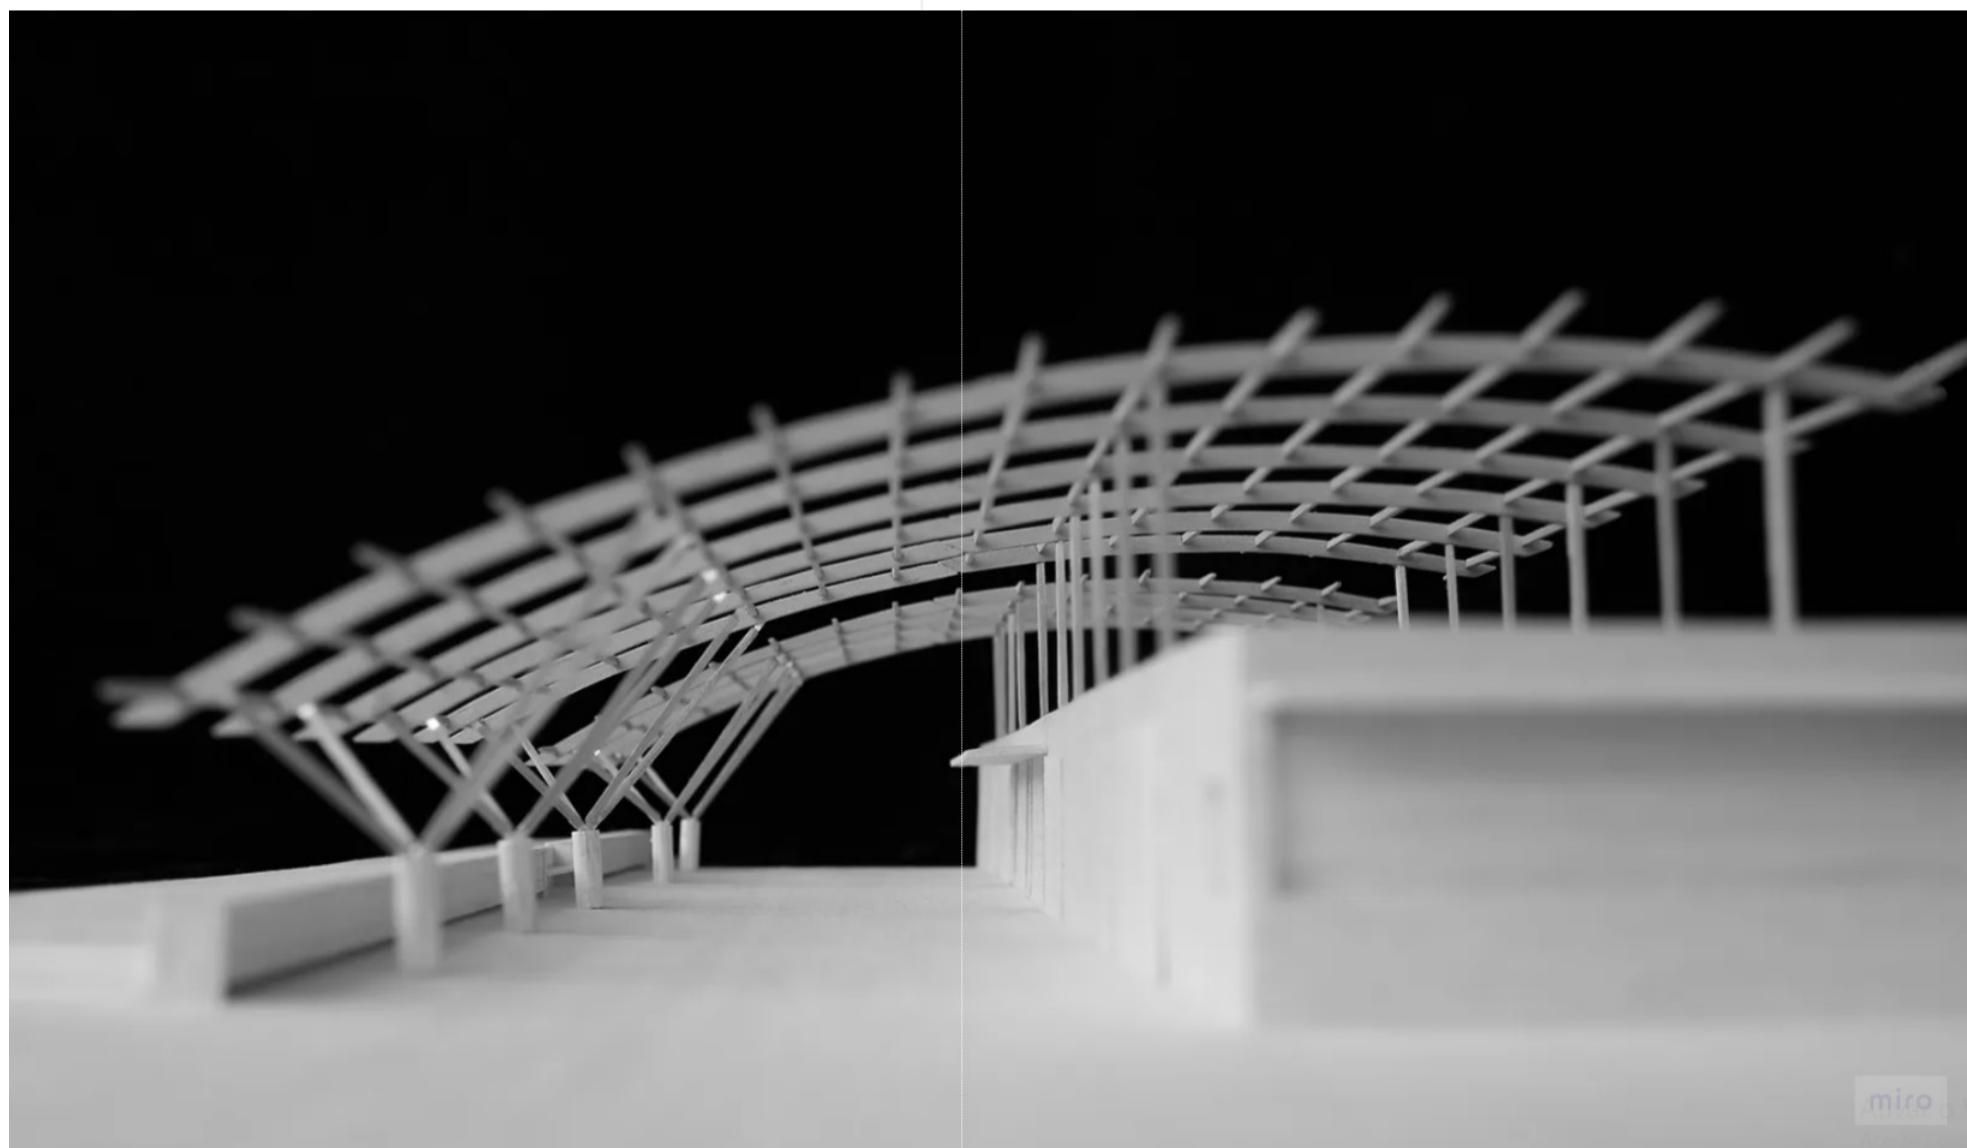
Maquete do projeto do Ateliê Acaia. Fonte: Site Atelie.
